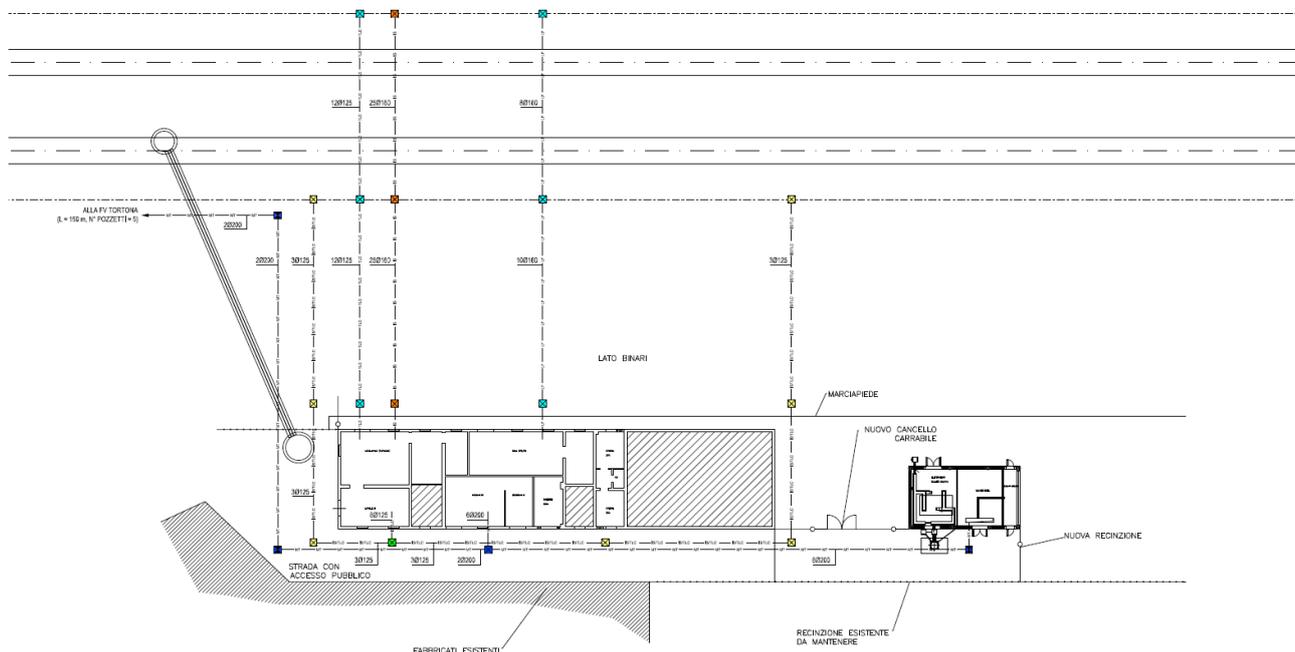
Planimetria sottoservizi area fabbricato tecnologico
